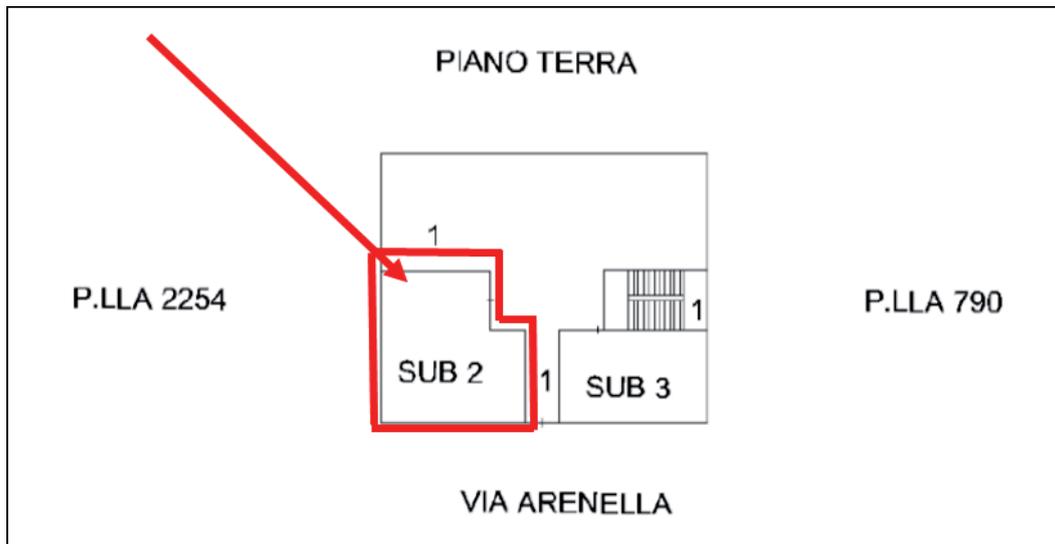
Stralcio di Elaborato planimetrico del 12/09/2016
